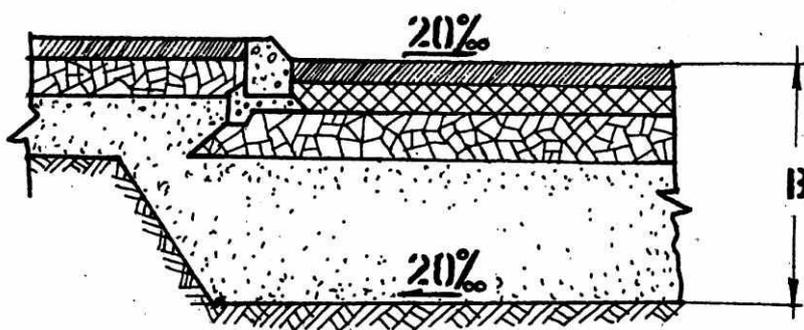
Схема конструкции сопутствующего дорожного дренажа без водоотводящей дренажной трубы
